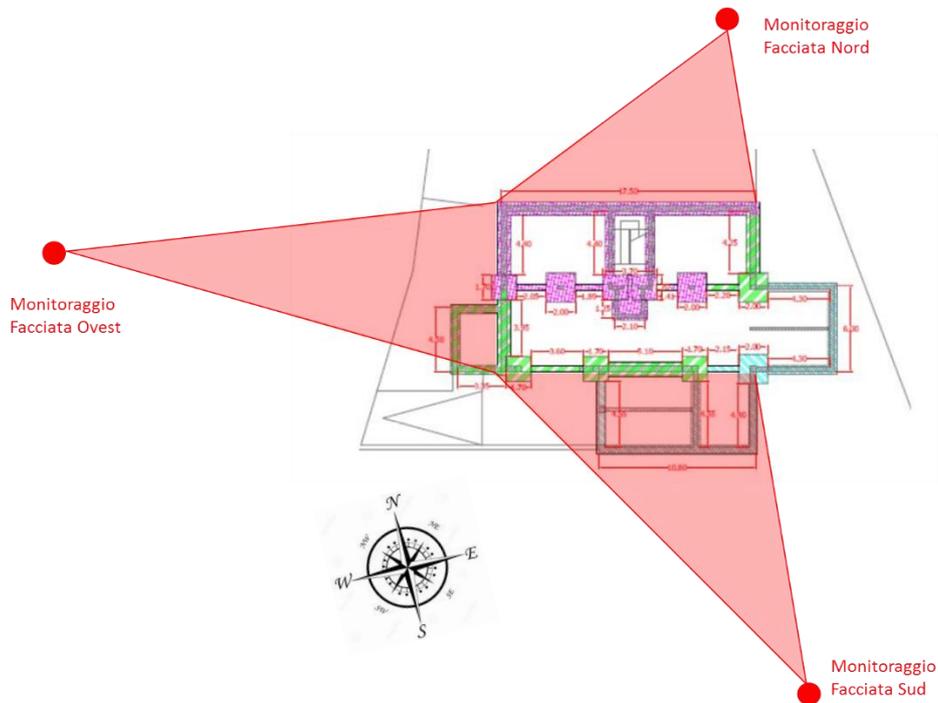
Planimetria del cantiere e posizionamento del radar
